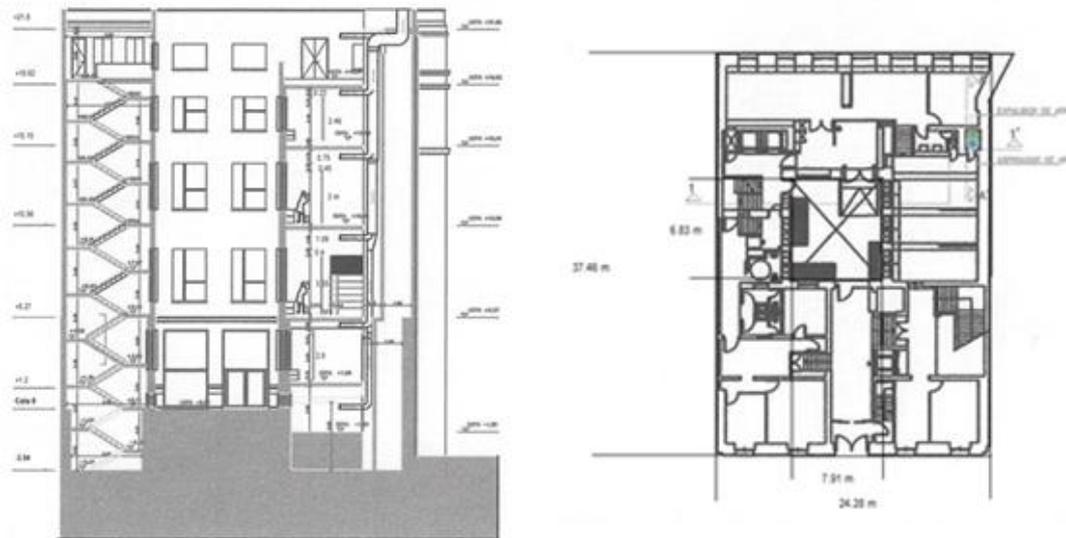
Detalle del edificio. Sección vertical y Planta baja
